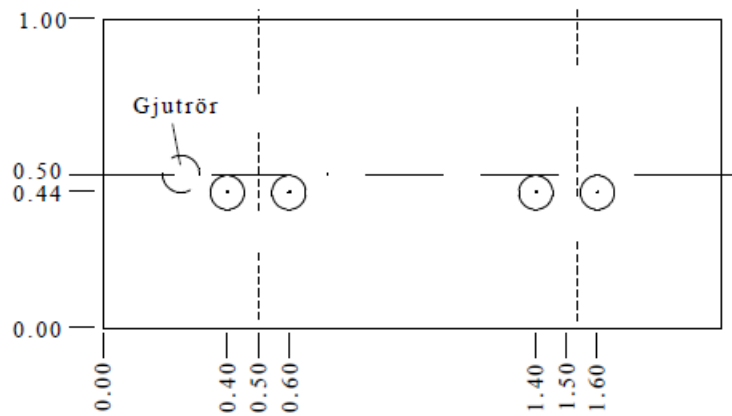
Anslutning mellan armering och betong såg bra ut. vid andra armeringsraden med hänsyn till gjutrörets placering
